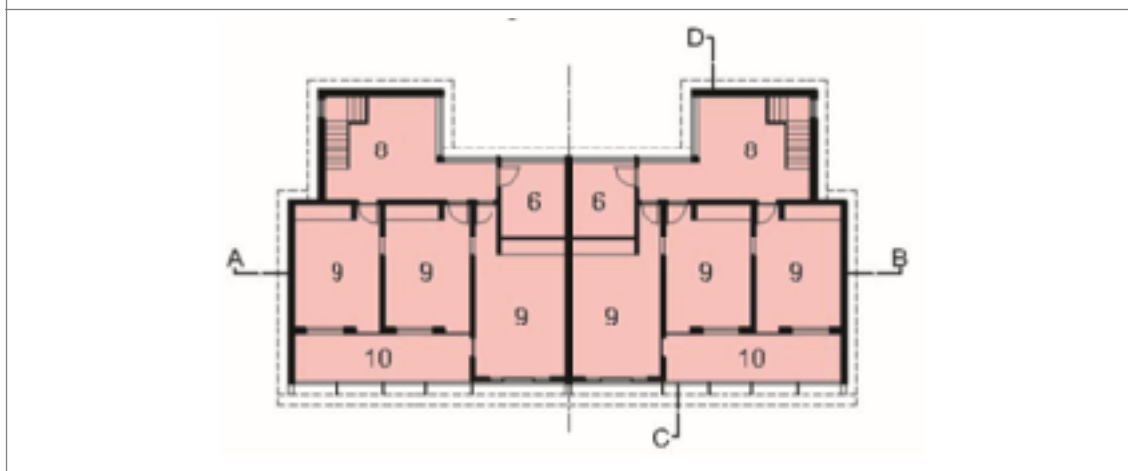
Planta baixa pav. superior e sinalização em vermelho do ambiente a ser analisado.
